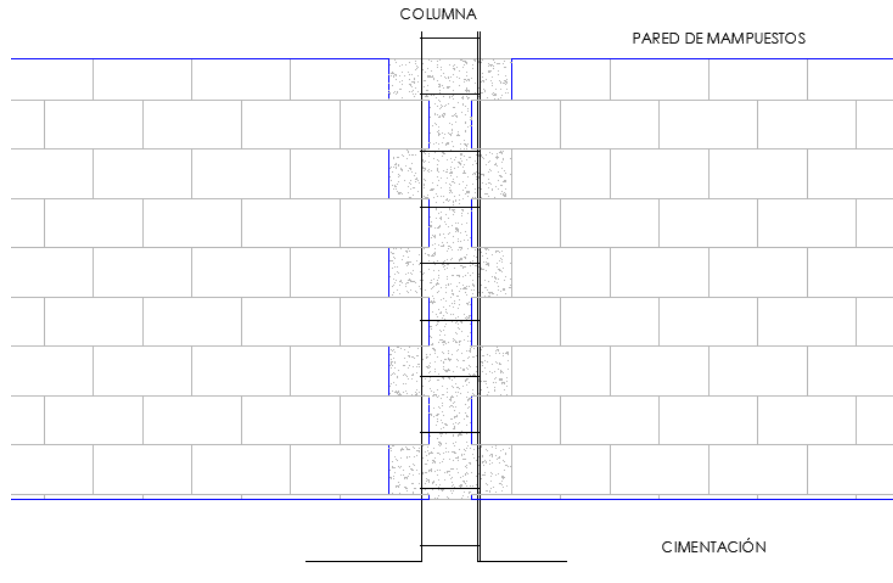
Corte transversal de la columna en mampostería reforzada.
